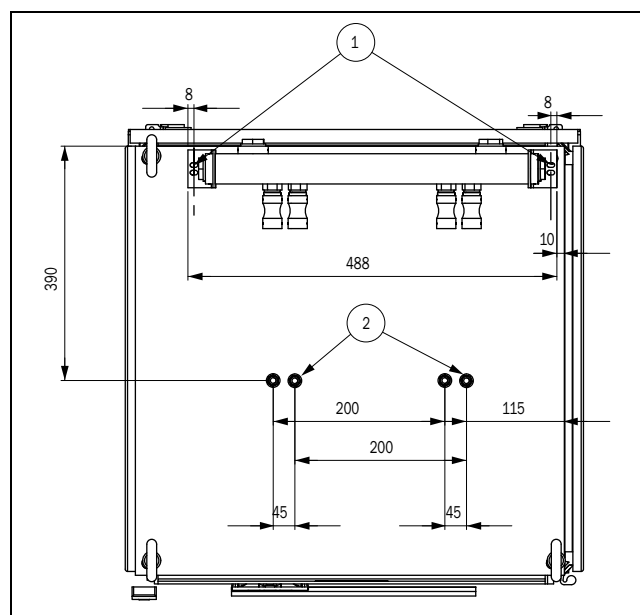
Mengenteiler für Rahmengröße H(69), Draufsicht
